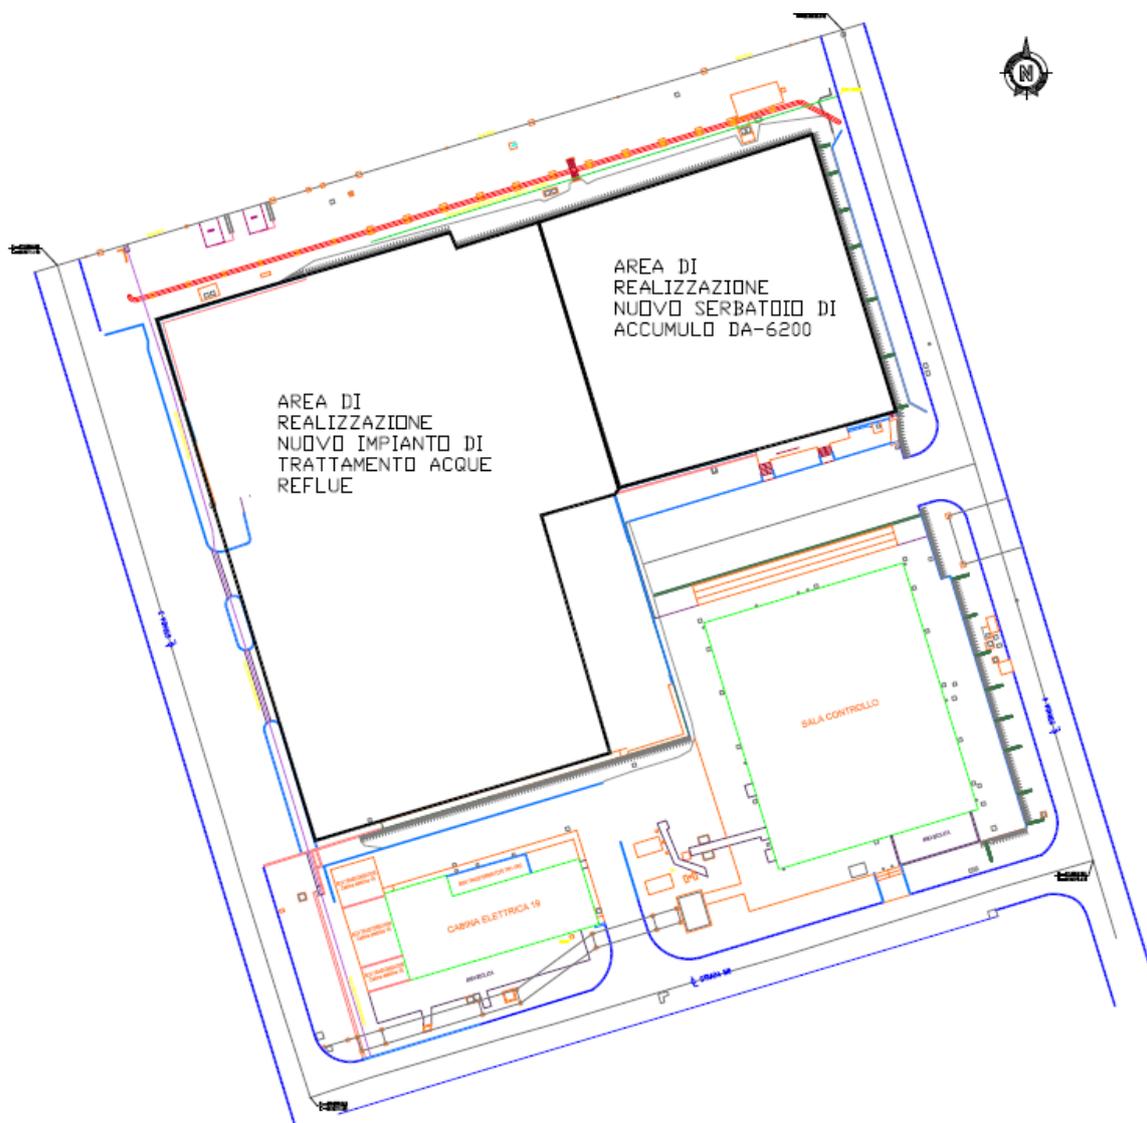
Posizionamento planimetrico nuovo impianto modulare di trattamento acque reflue Versalis
